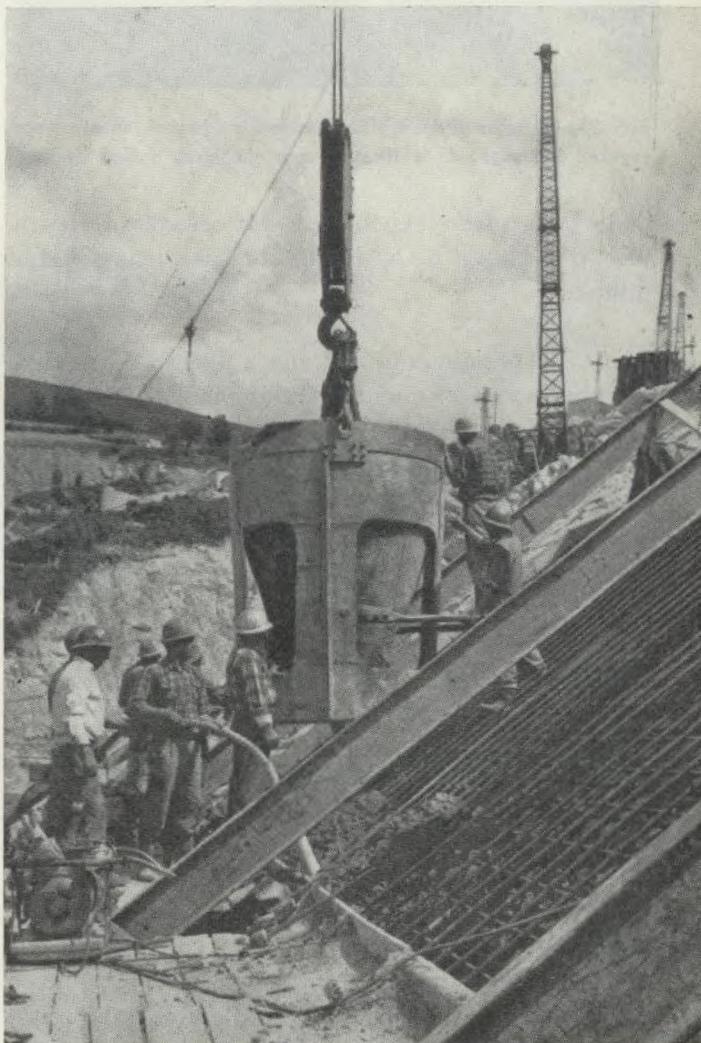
Betonagem de uma laje. Vêm-se as vigas metálicas de deslização da cofragem
